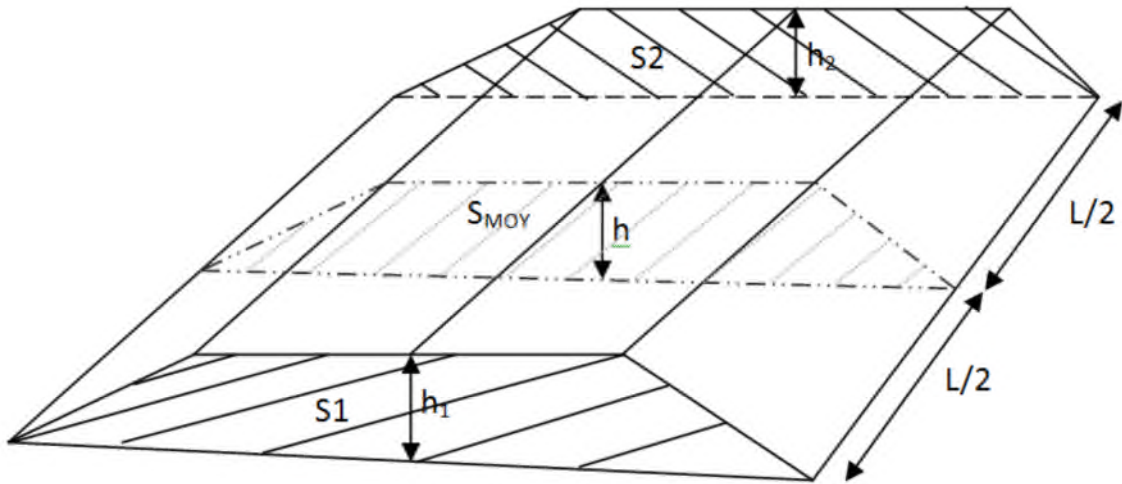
Les sections d'un profil en travers d'un tracé donné
